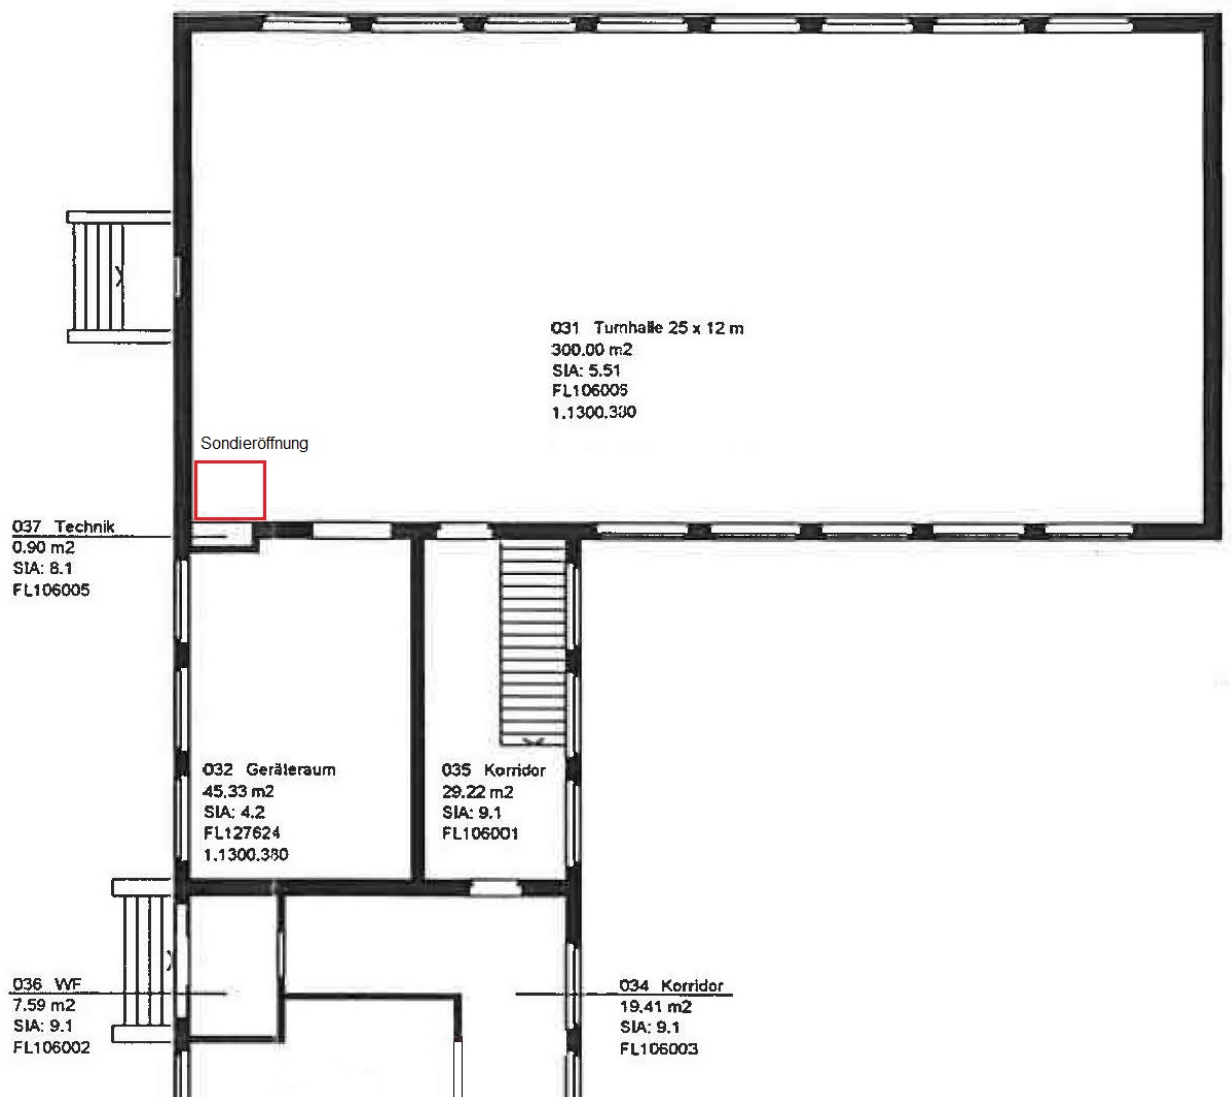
Grundriss Turnhalle mit Sondieröffnung
